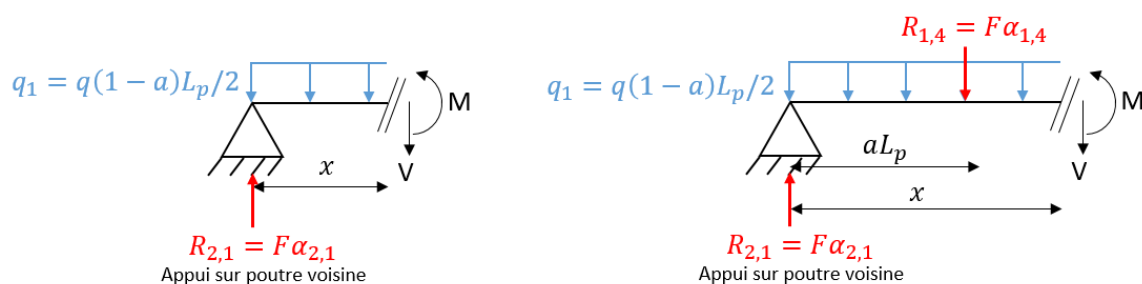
Poutre type 2 - coupe 1 (gauche) et coupe 2 (droite)
